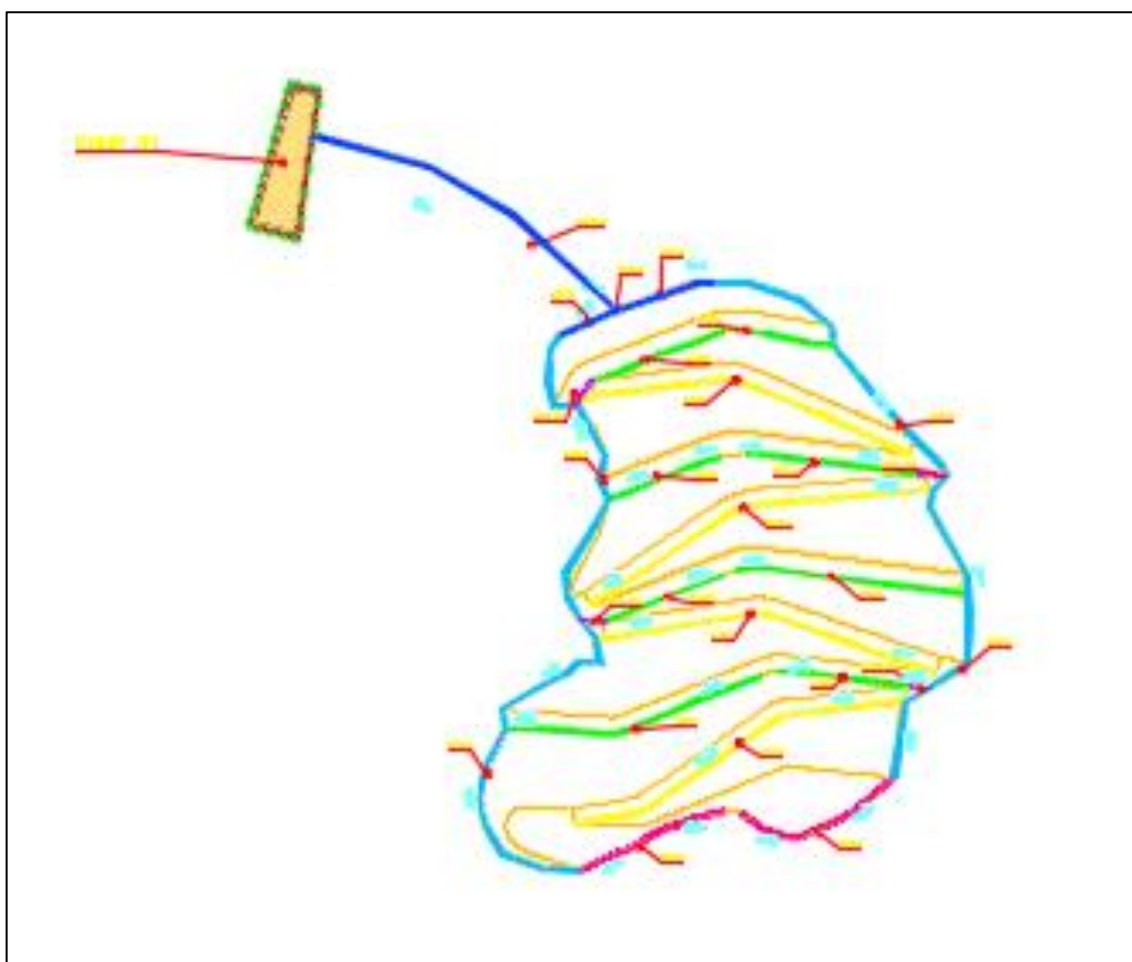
Arranjo geral de implantação das estruturas de drenagem superficial
